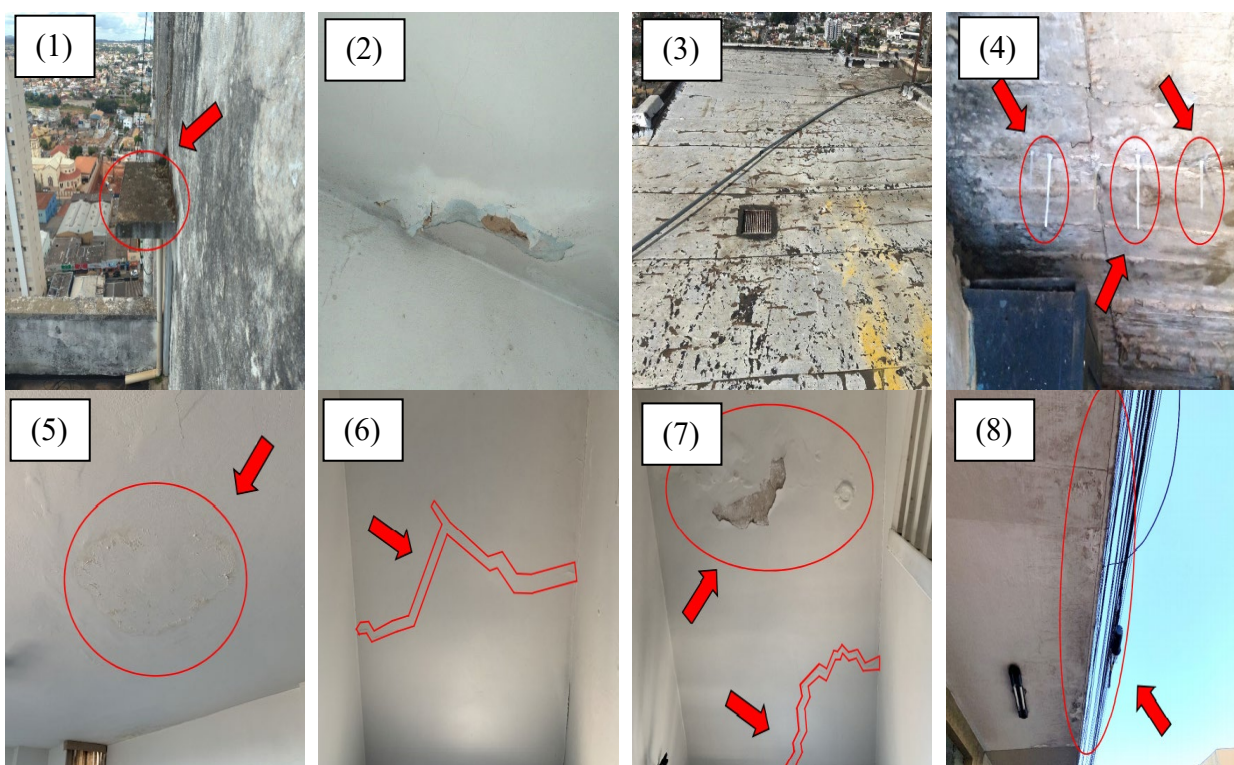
Manifestações patológicas identificadas nas lajes. (1) Manchas escuras no elemento L01. (2) Destacamento da pintura no elemento L02. (3) Desgaste da impermeabilização no elemento L03. (4) Eflorescência com formação de estalactites no elemento L04. (5) Pequenas manchas de umidade no elemento L05. (6) e (7) Fissuras devido carregamento adicional na cobertura, nos elementos L06 e L07. (8) manchas escuras de umidade no elemento L08.
